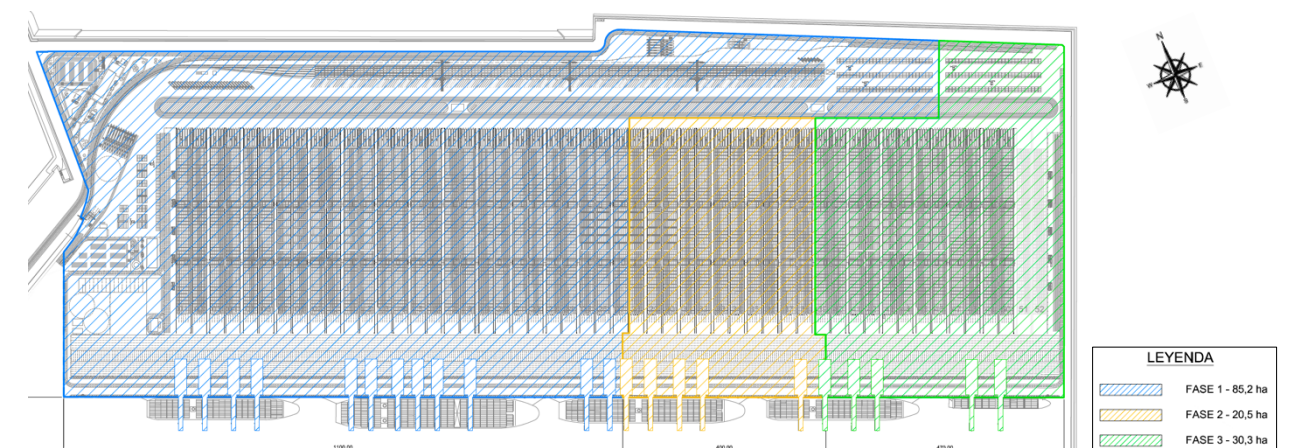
Planta general de la terminal VNPT de desarrollo por fases. Fuente: TIL/MSC
